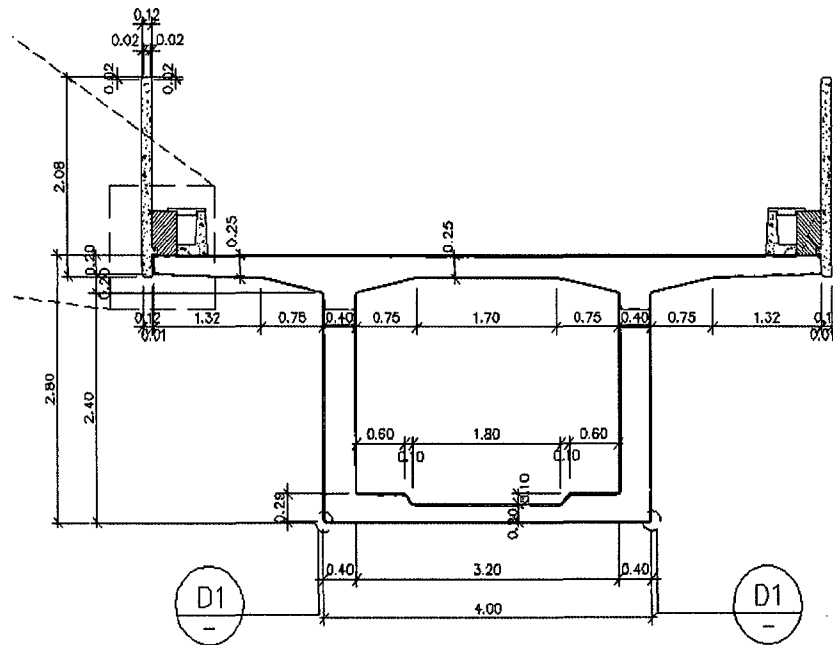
Sección Típica en el vano del tablero del módulo 17
